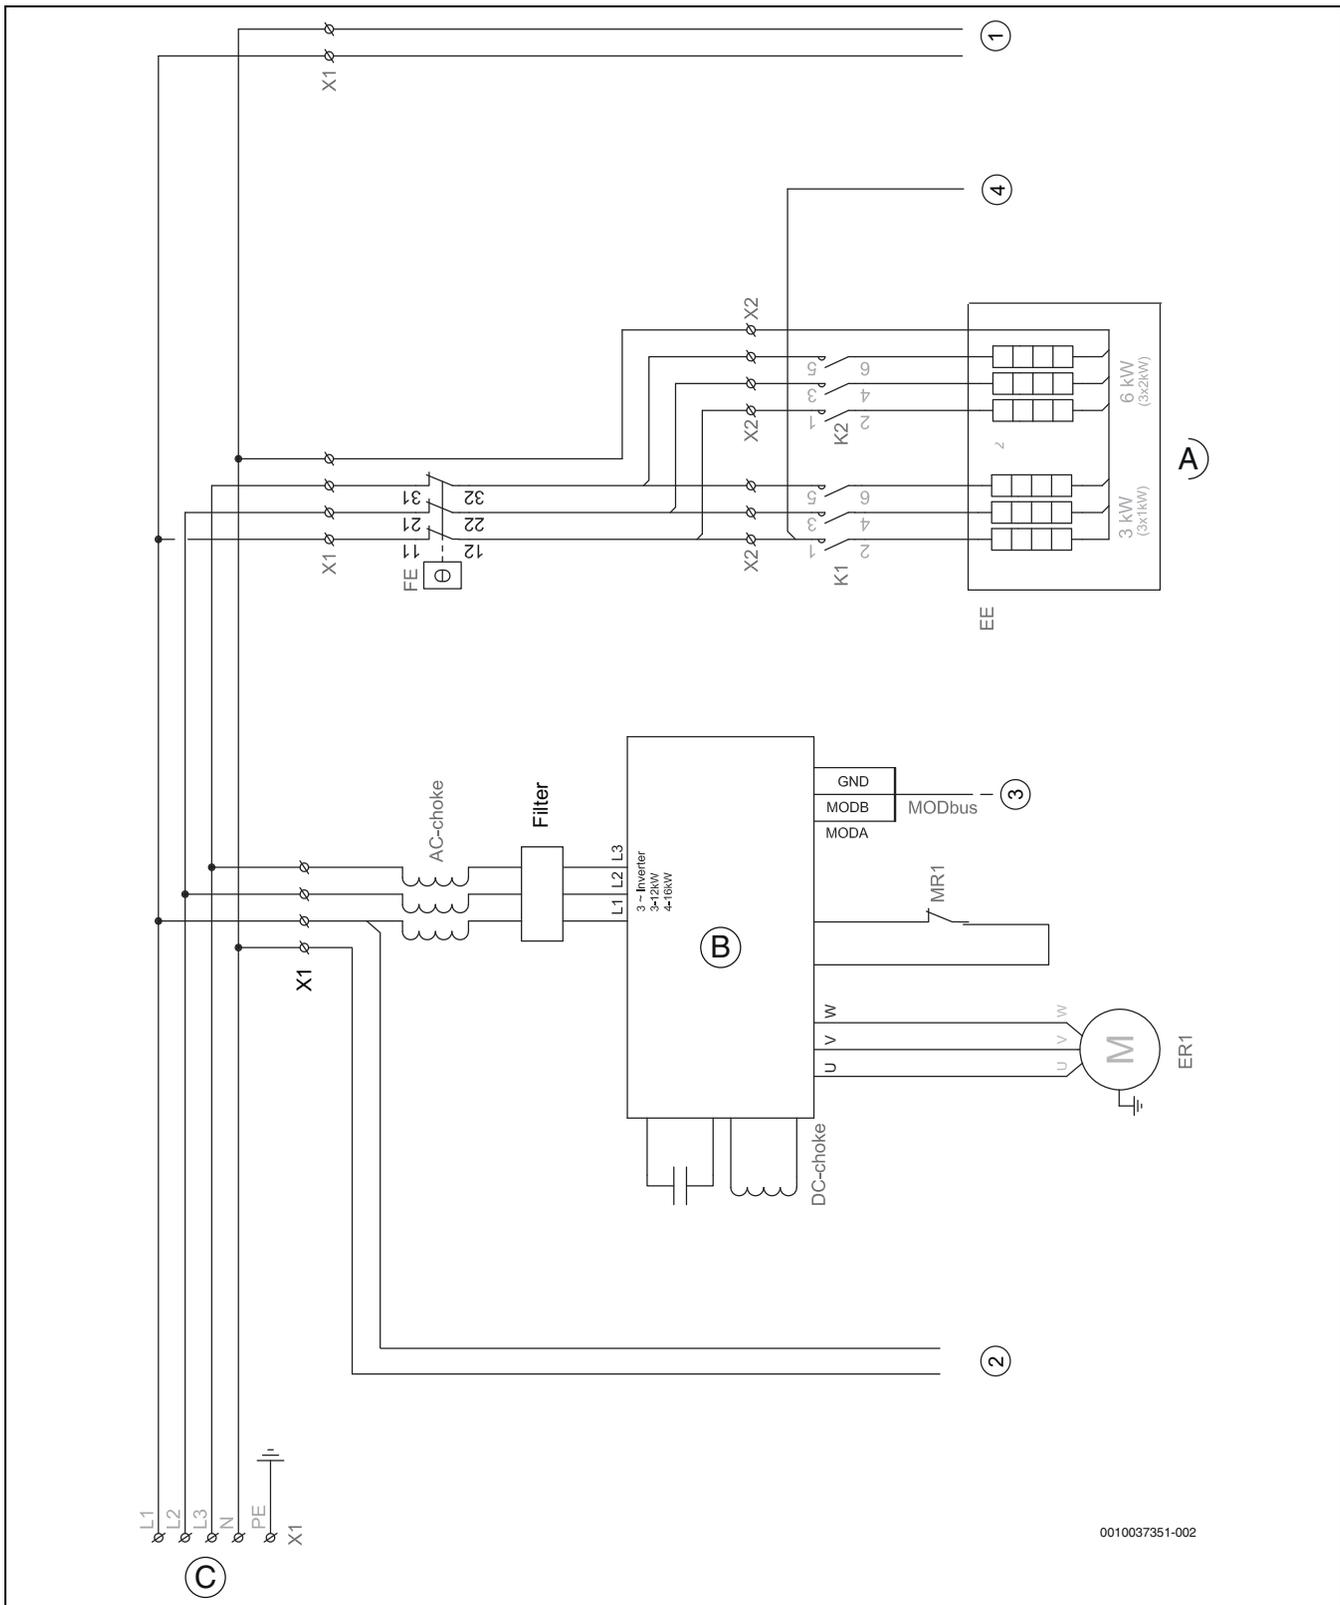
Schaltplan Hauptkreis, 6-8 kW
